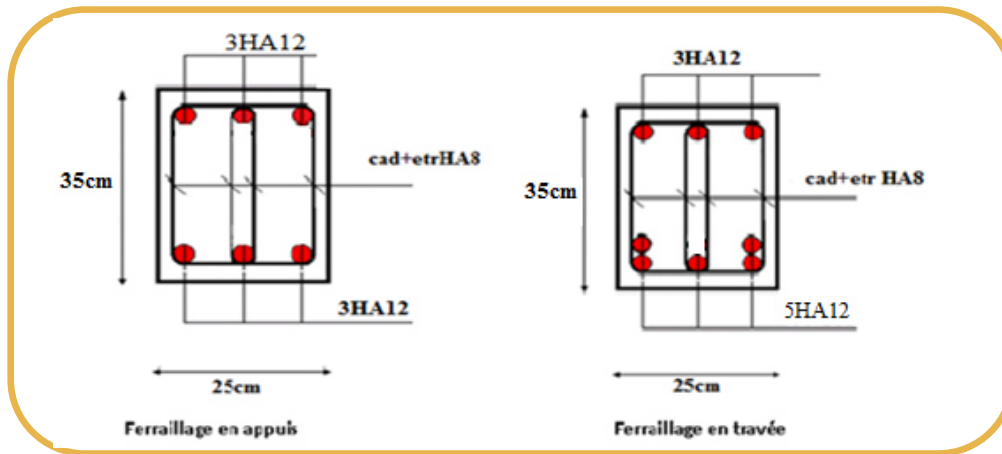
Schéma de ferrailage L'escalier de RDC.
